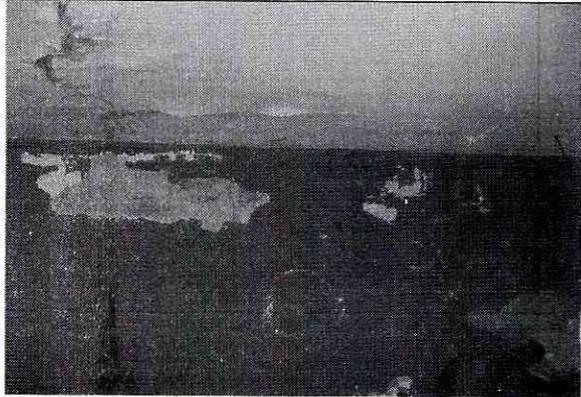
Humedad en muros y cielo raso del segundo piso de la zona posterior
